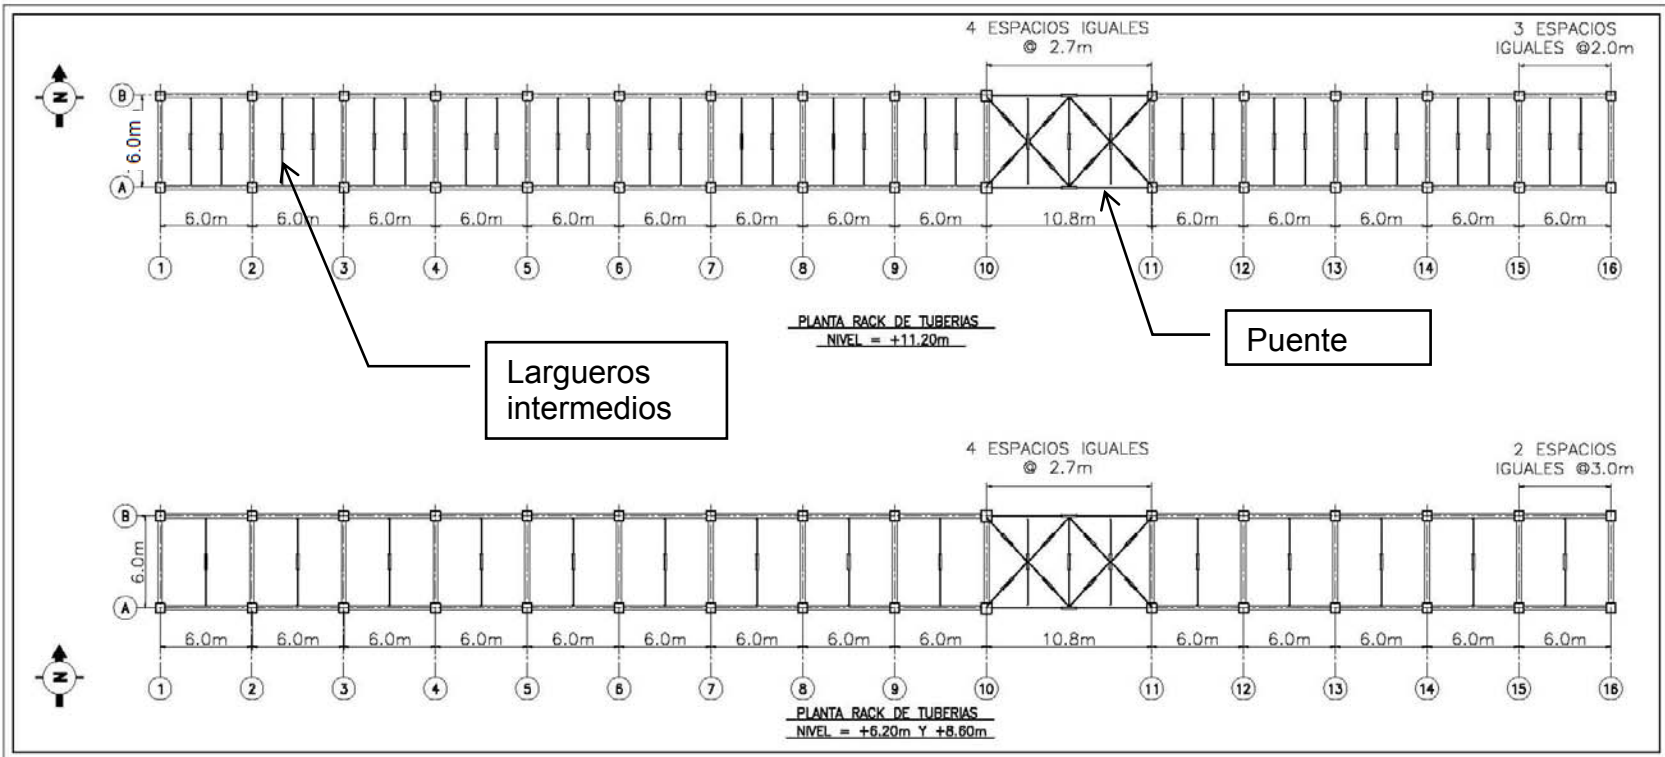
Dimensiones en planta del Rack de Tuberías.
